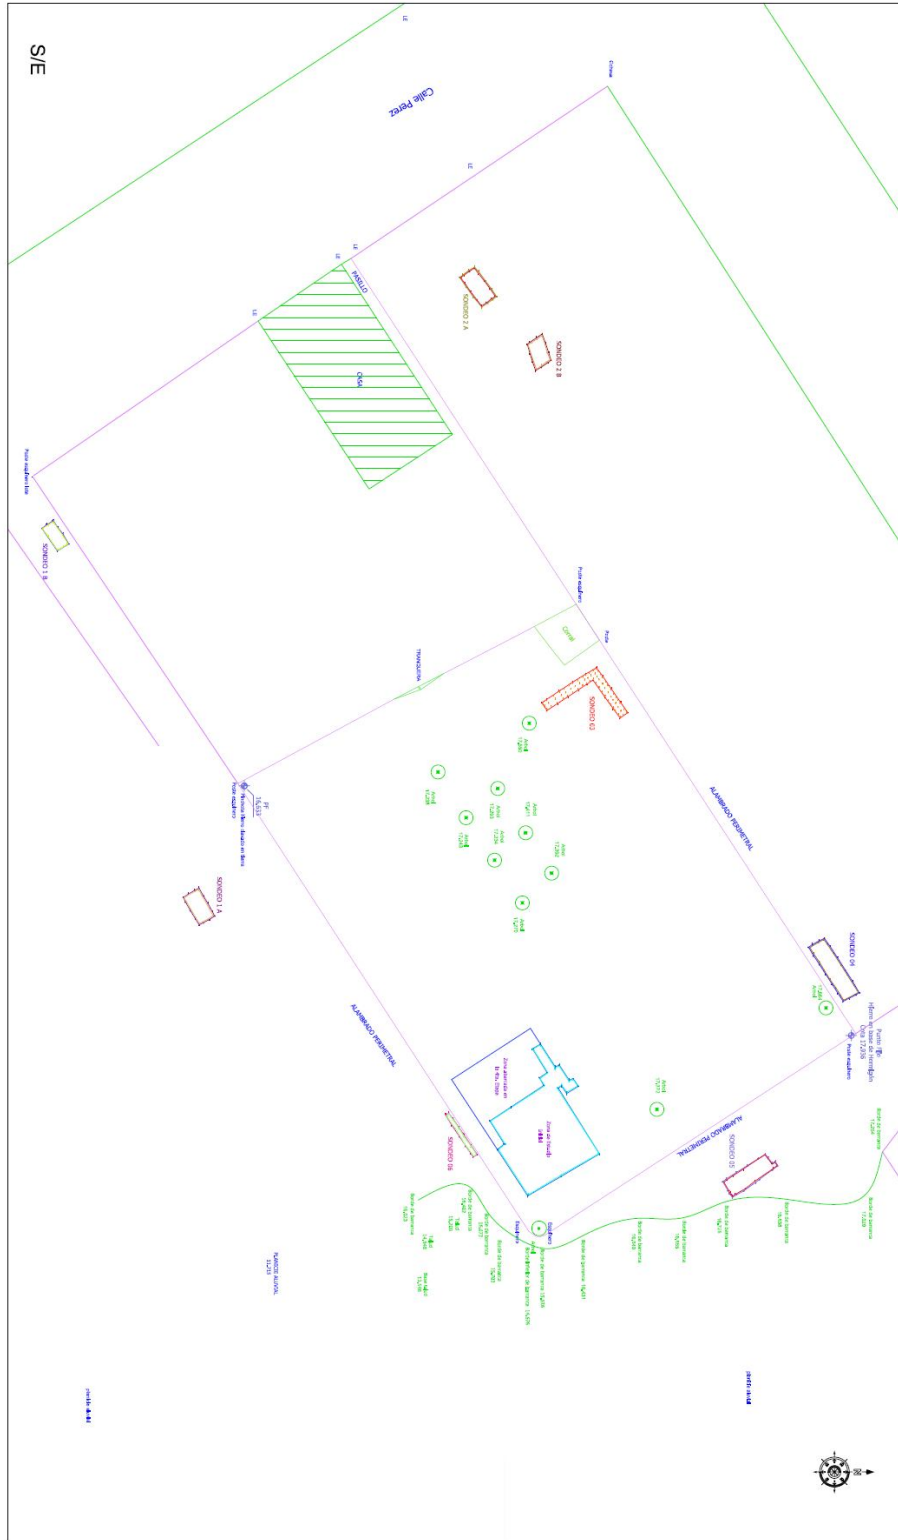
Planimetría con la ubicación de los sondeos y áreas de excavación
